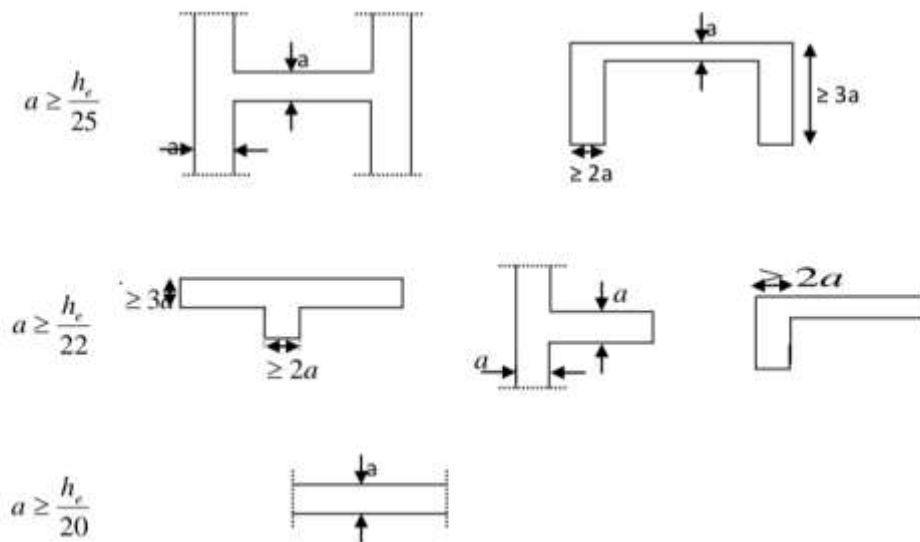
Conditions de rigidité aux extrémités des voilesRez-de-chaussée :
